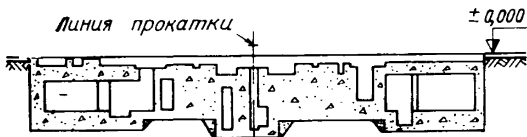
Пример решения массивных фундаментов под прокатное оборудование
